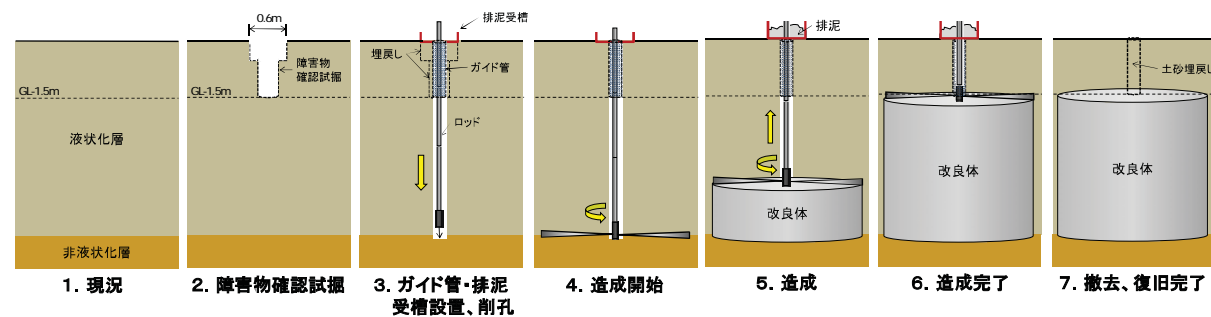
高圧噴射攪拌工法の施工手順 (宅地部を標準)
